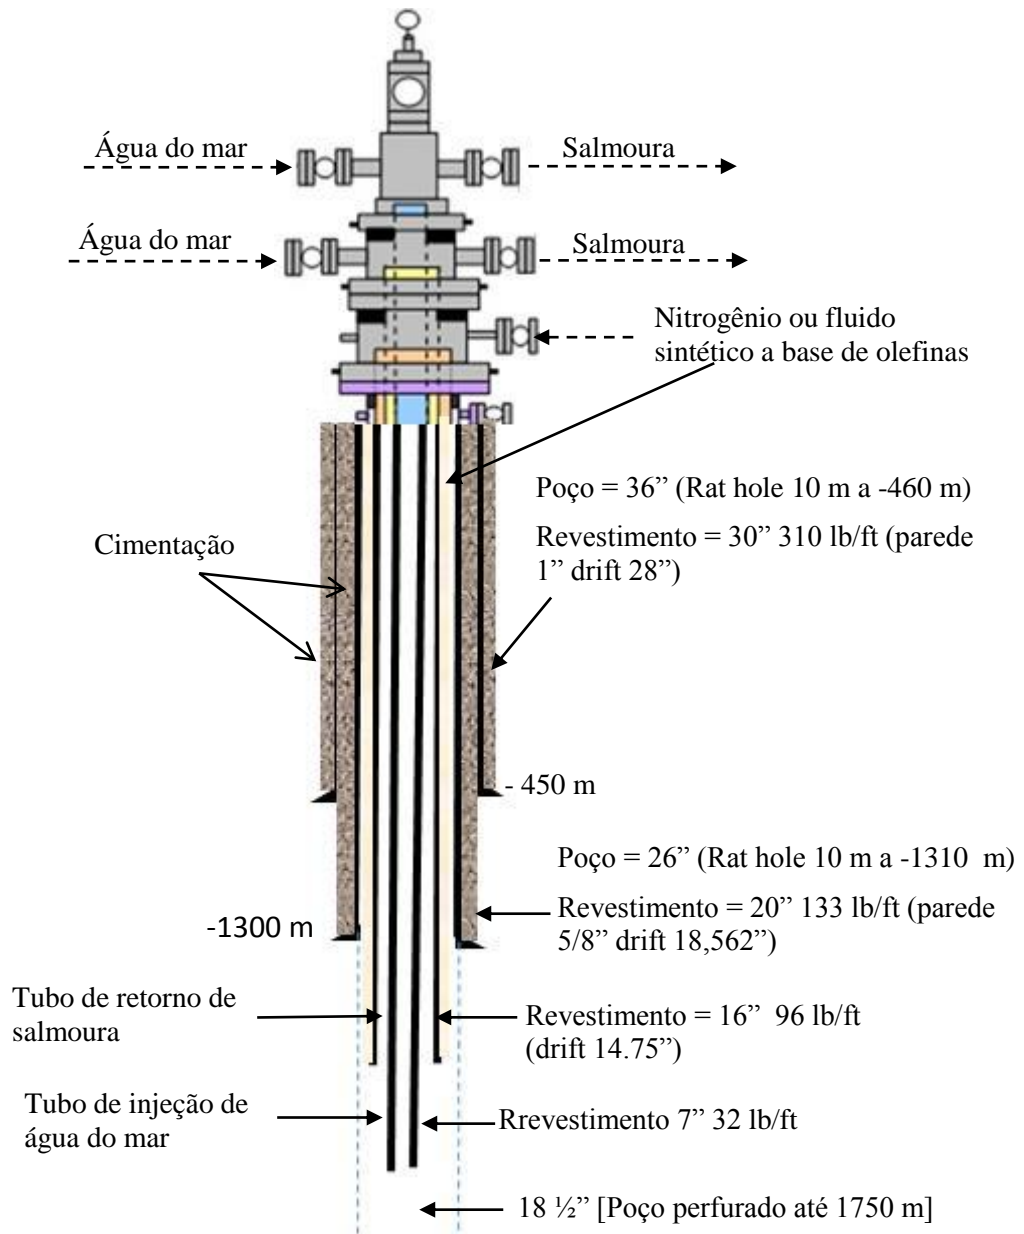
Projeto de completção do poço para construção e operação das cavernas
